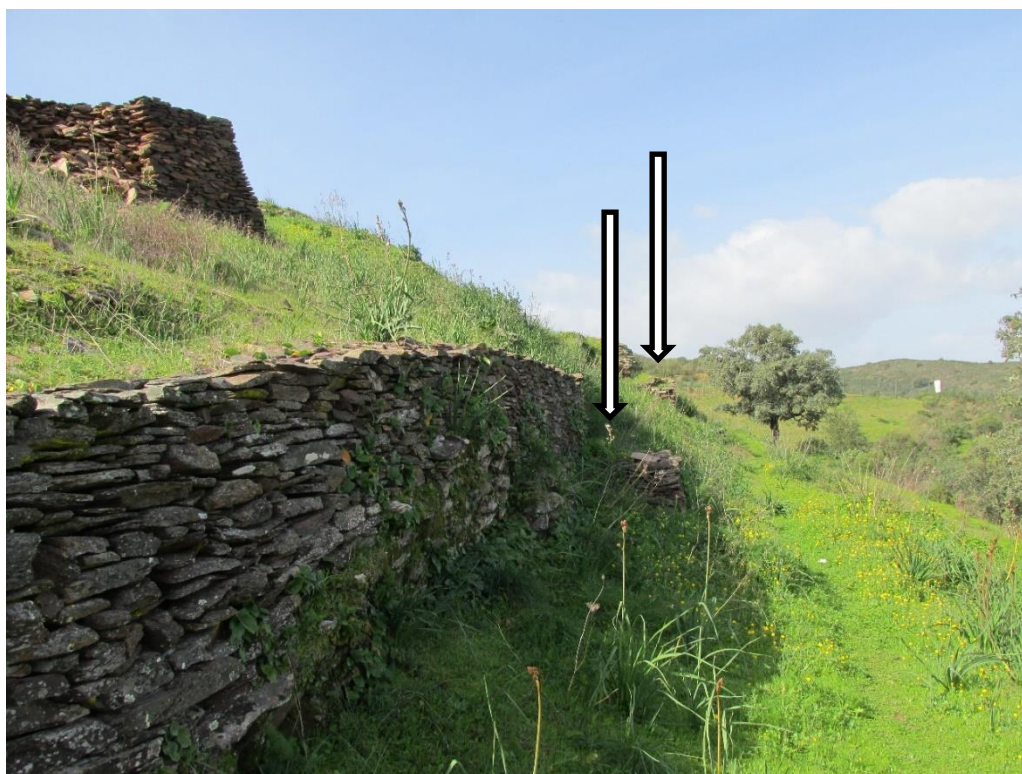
Tramos da muralha externa, onde se verificam a independência estrutural das muralhas em relação às torres. Carlos Esquetim 2017.
